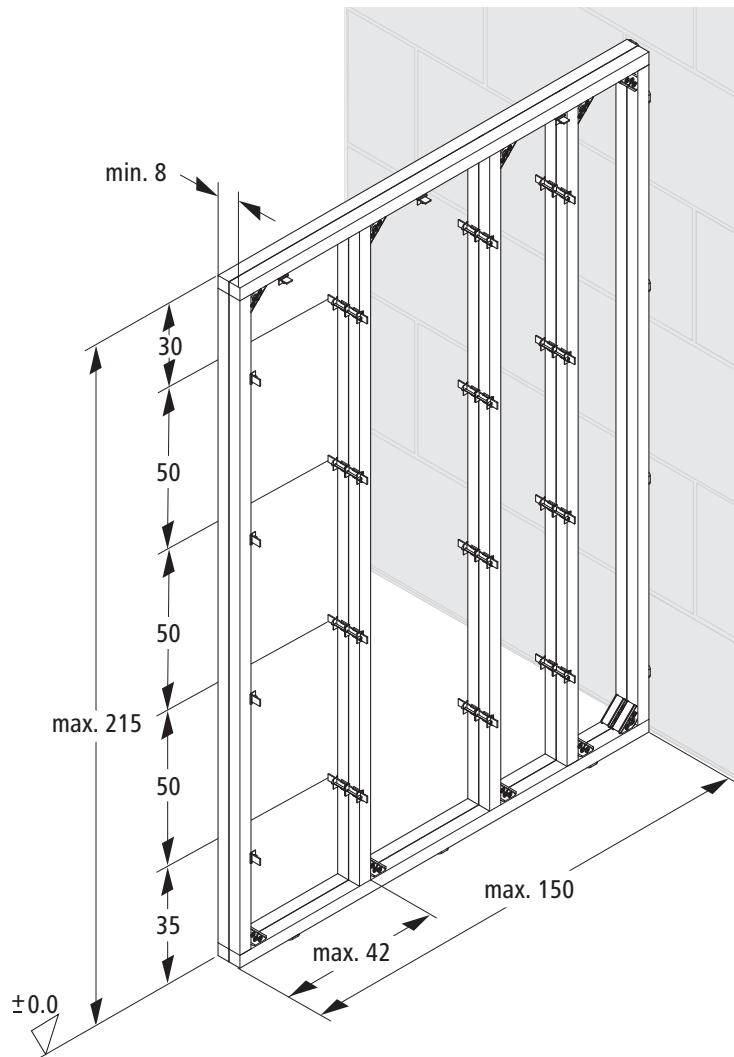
Dimensions de montage demi-paroi 8 cm × 150 cm × 215 cm, avec parement, avec pièces d'assemblage parallèle
